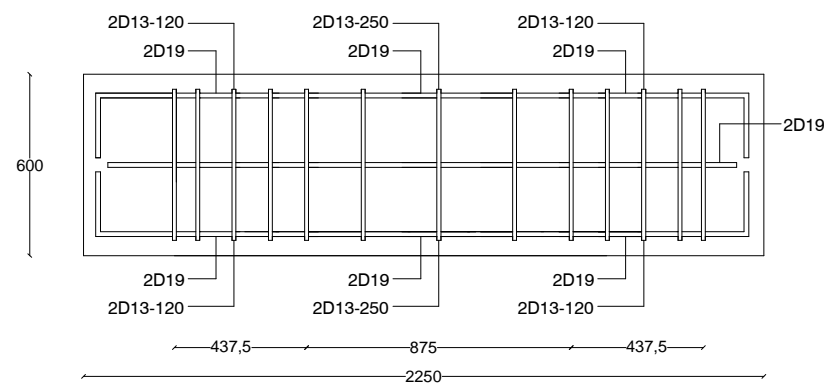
DETAIL PENULANGAN BALOK MELINTANG TRESTLE
